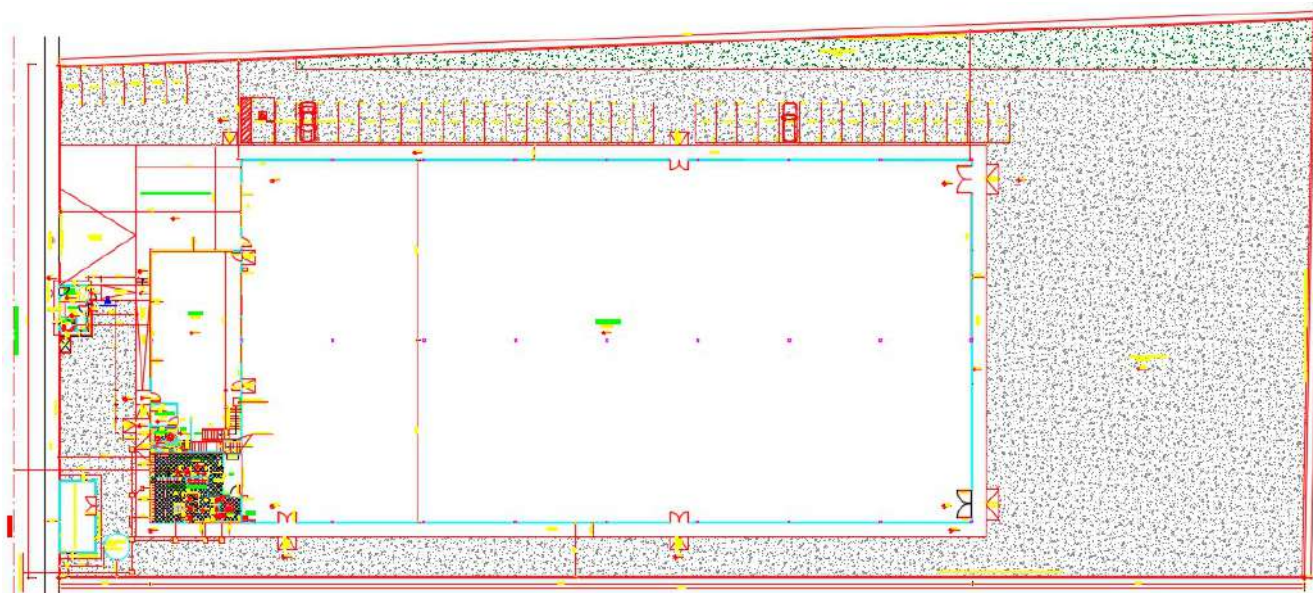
Implantação do empreendimento - recorte do Projeto Arquitetônico
